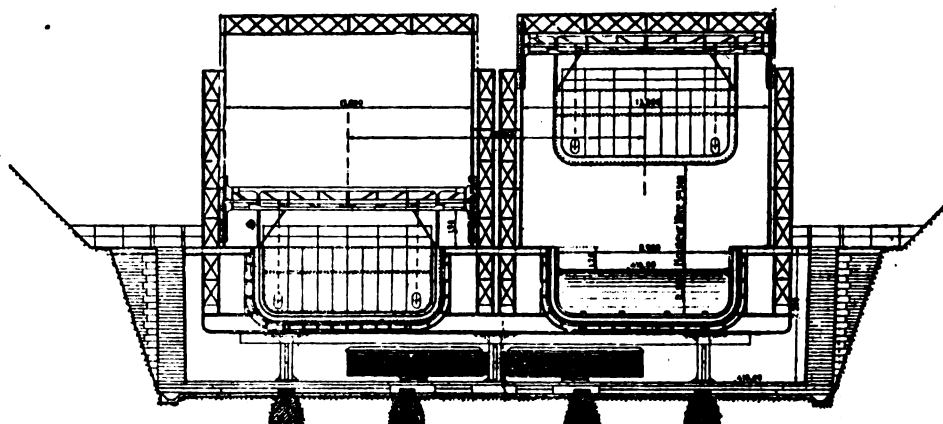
Vista in sezione trasversale della testa di canale superiore.
